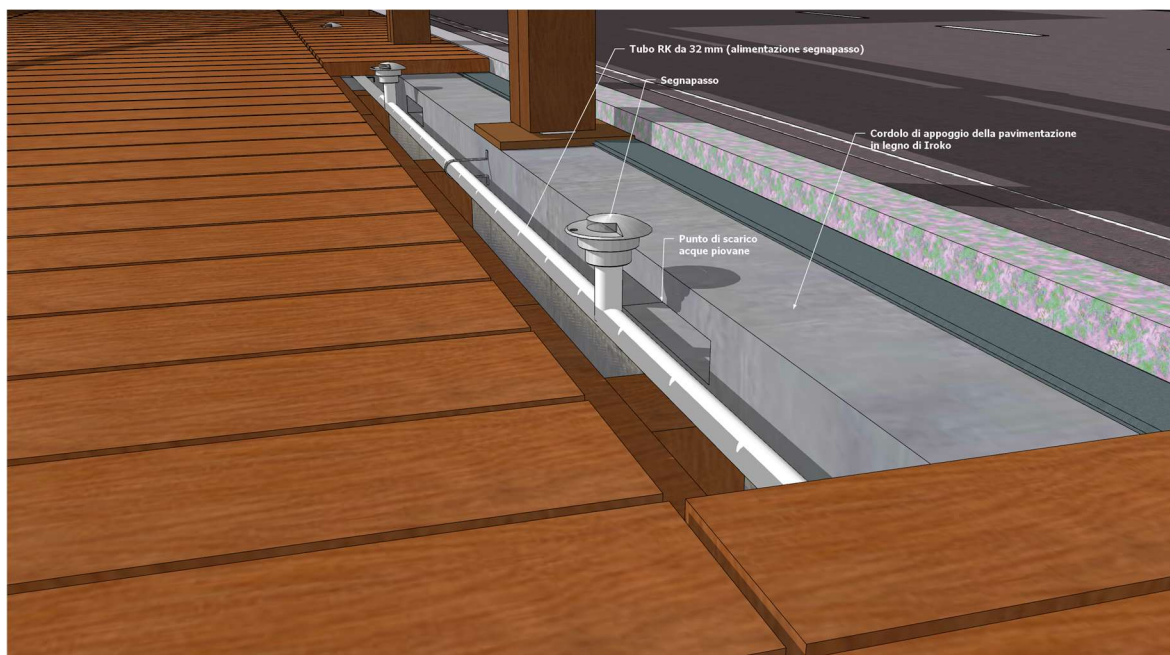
Vista di dettaglio sistema di illuminazione con segnapasso a led
